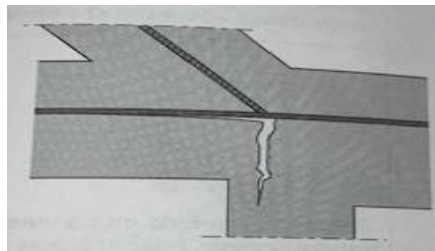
Fissuration verticale en prolongement d'un joint [13].
